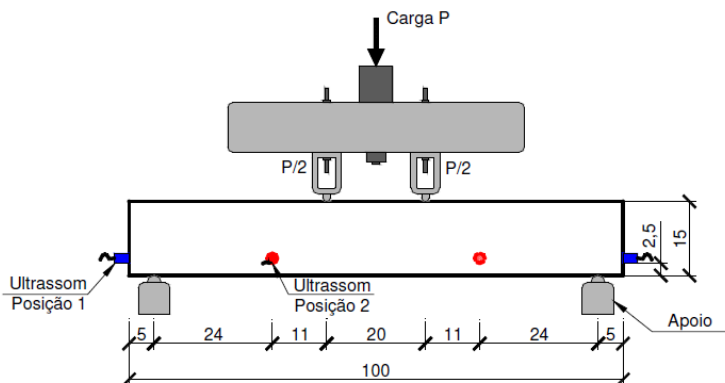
Esquema do ensaio de flexão a quatro pontos e posições de leitura para ensaio ultrassônico.
